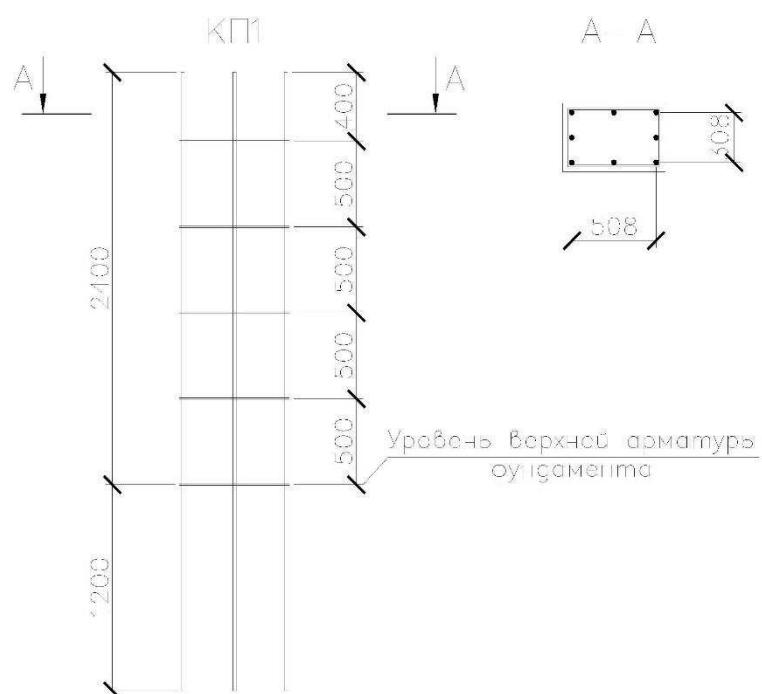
Соединение монолитной железобетонной колонны с монолитным фундаментом
